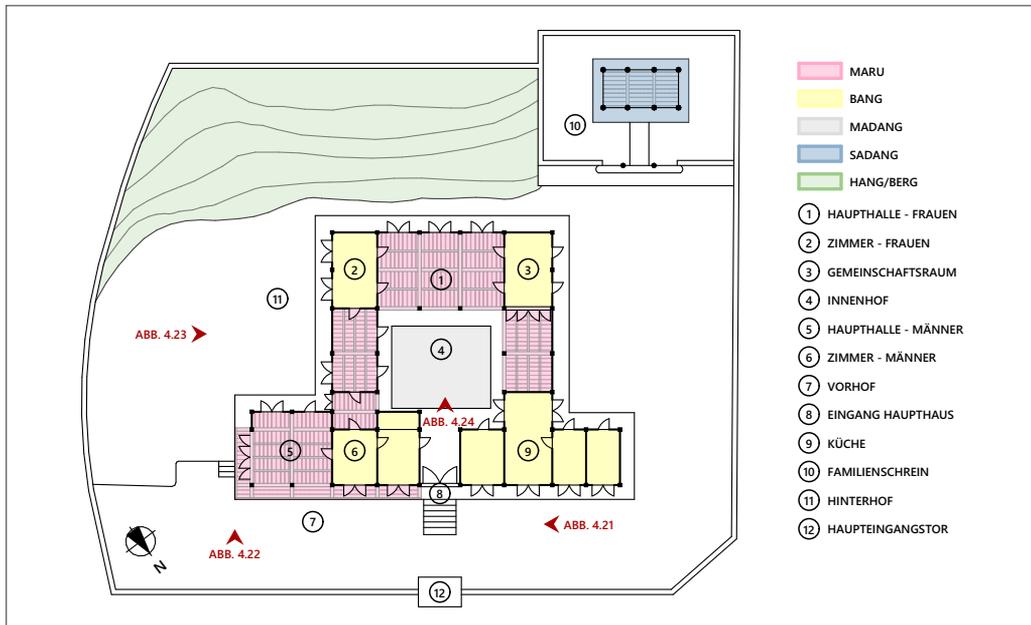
Lageplan des Gwangajeong in Yangdong Village
